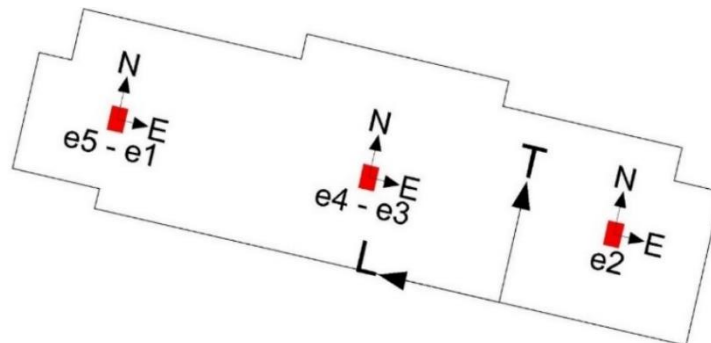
Vista en planta del edificio N°1. Ubicación, orientación y numeración de equipos utilizados
